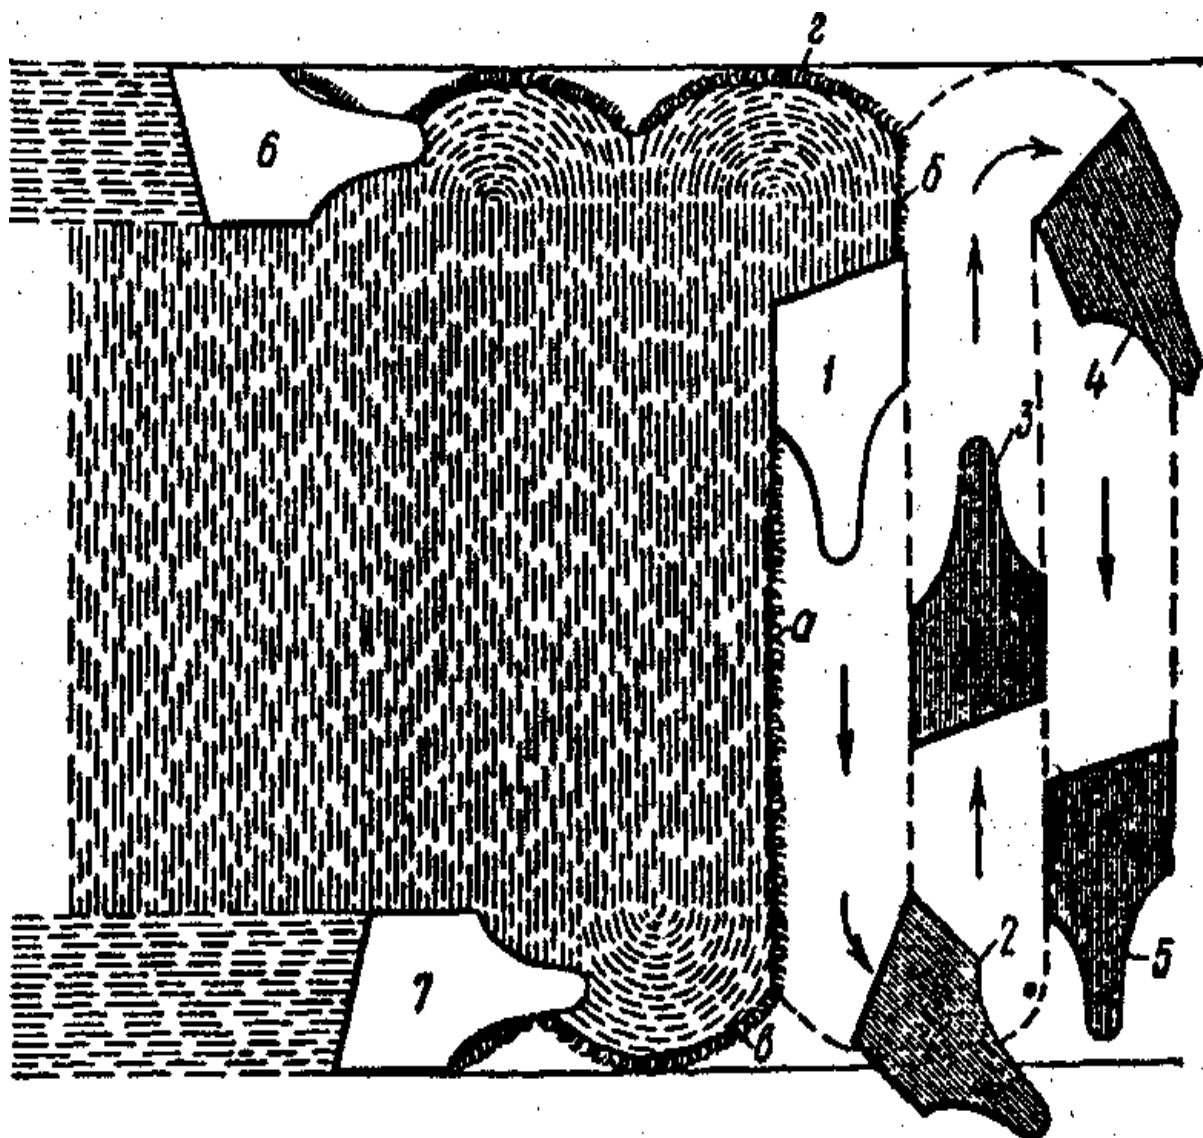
Перемещение шпателя при обработке больших поверхностей:
